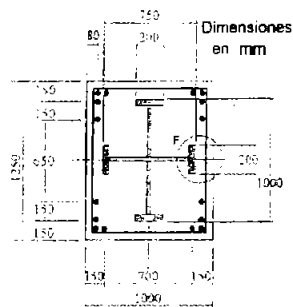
Columna de sección compuesta (Kang-Ning, 1996)
